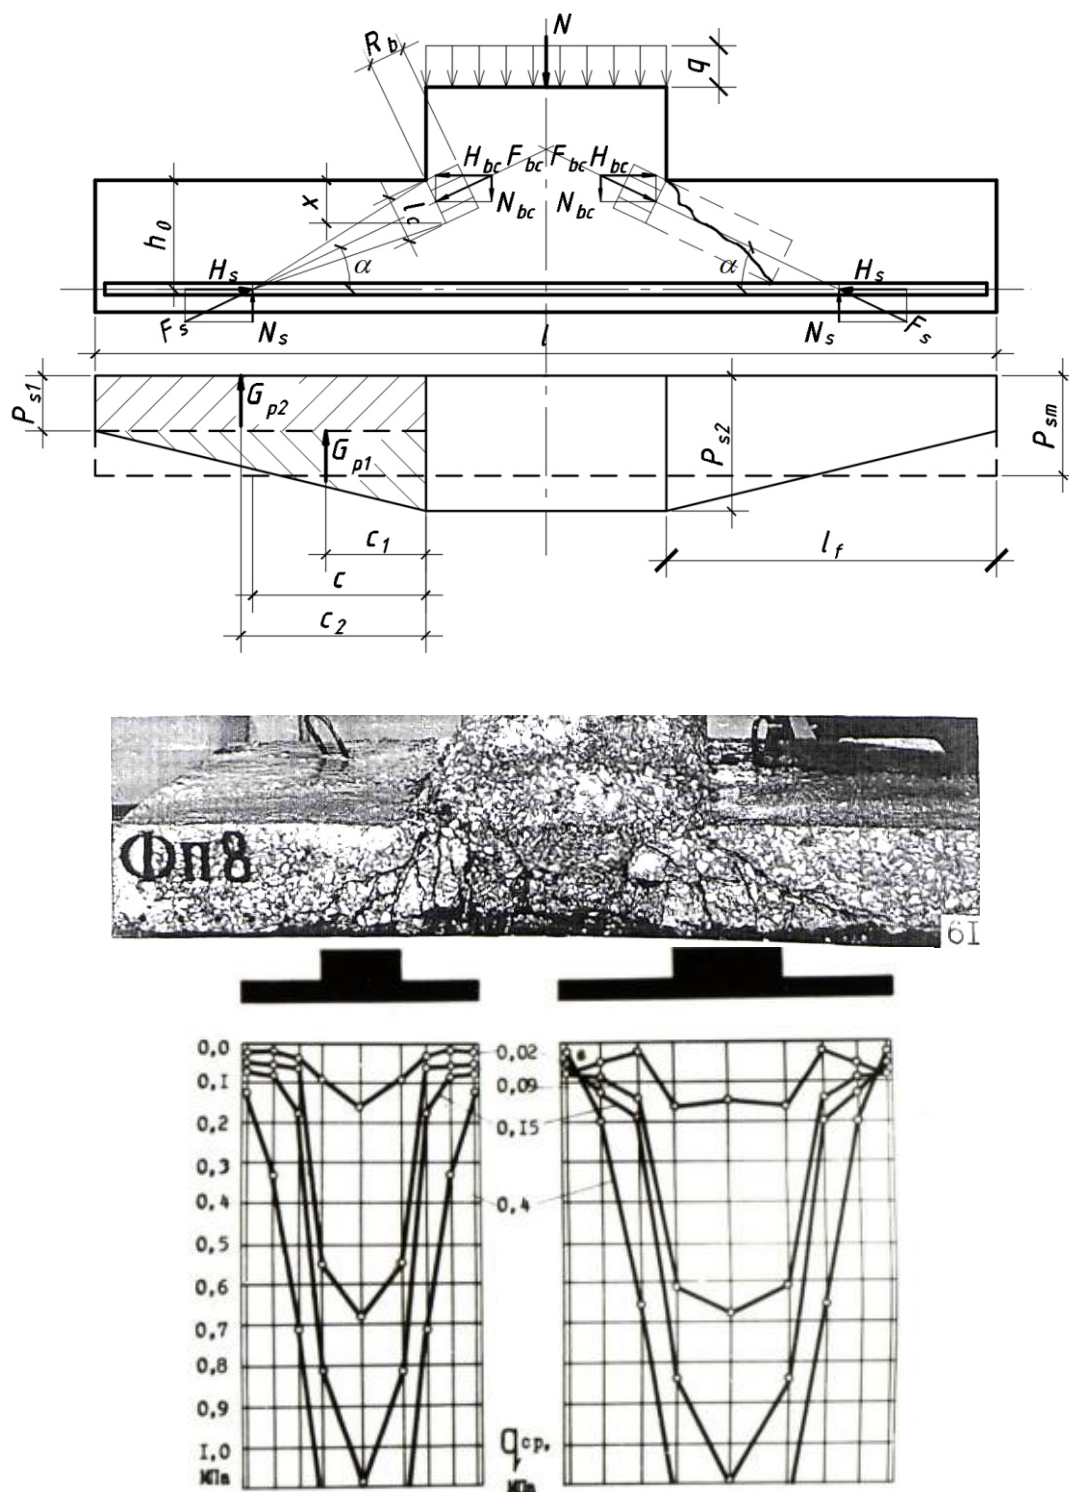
Схема усилий в сечении фундаментной плиты, схема образования трещин и трансформация эпюр контактных напряжений
